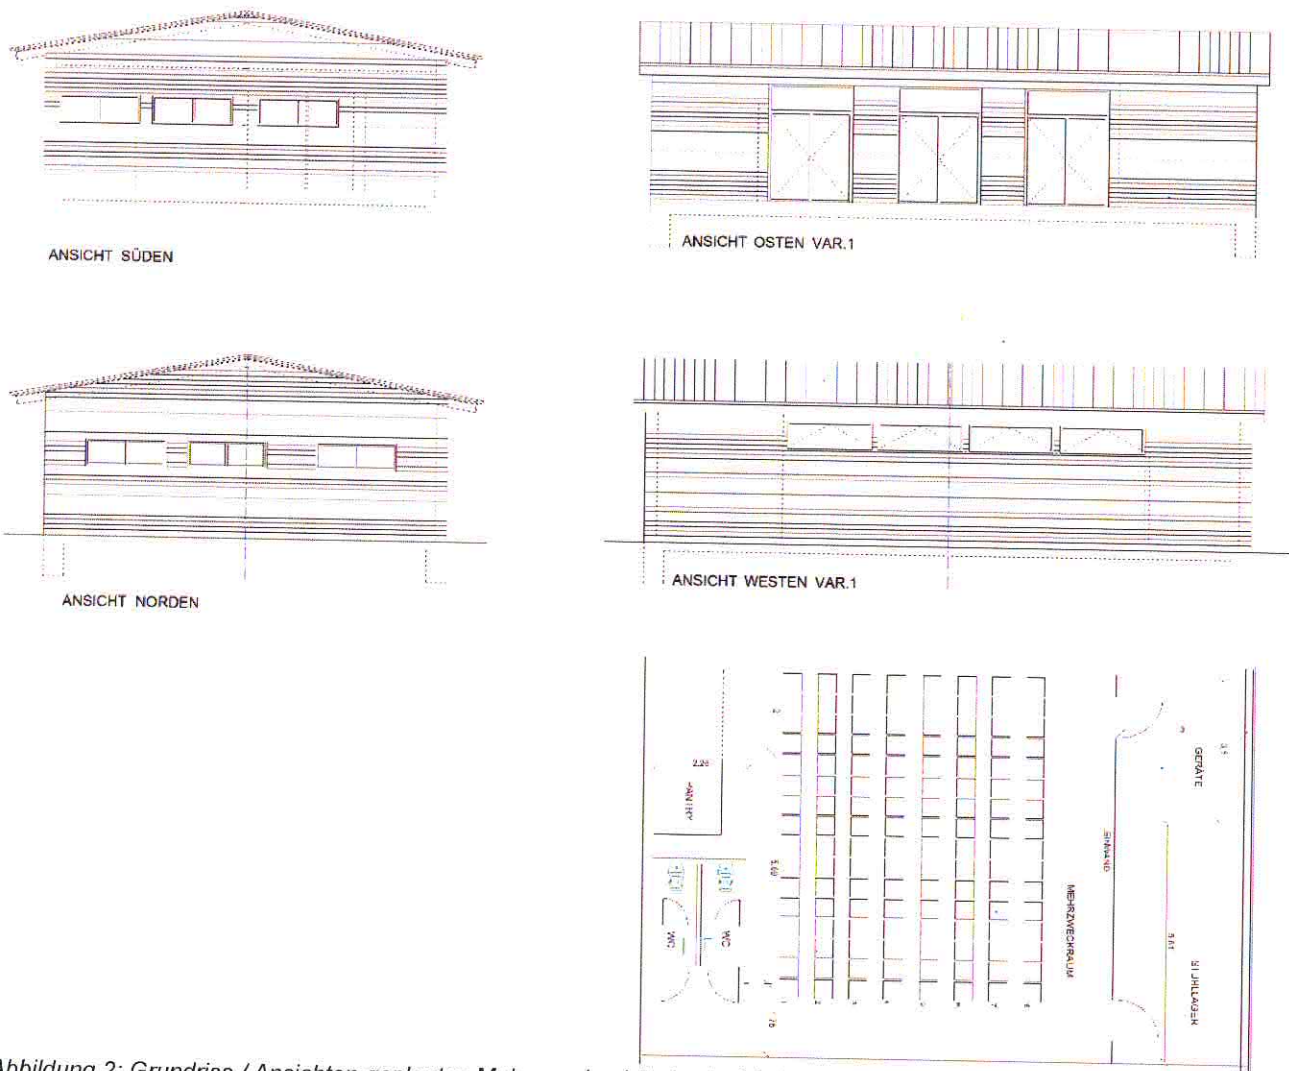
Grundriss / Ansichten geplantes Mehrzweckgebäude, Architektin Nessler
